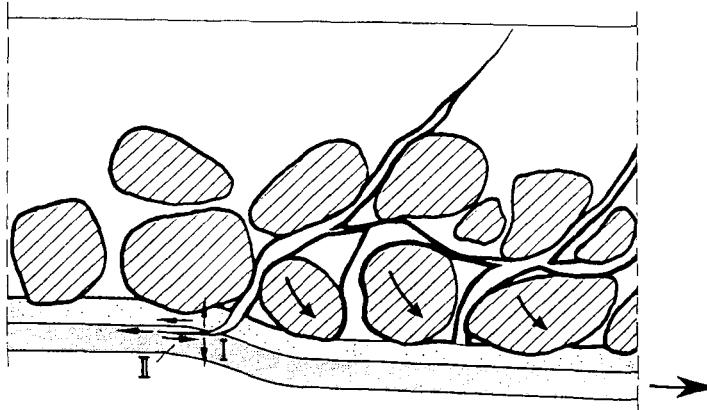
Übergang des Verbundrisses vom Beton in die Lamelle
